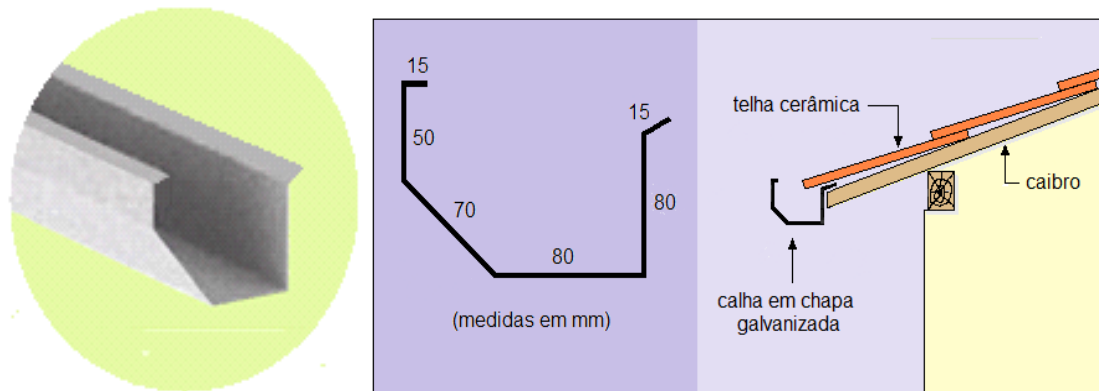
Dimensionamento do perfil de uma calha de beiral e seu esquema de montagem
